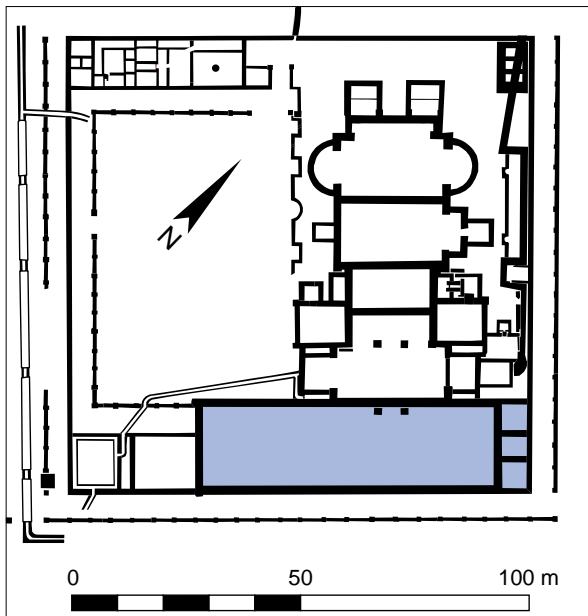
Xanten, Colonia Ulpia Traiana. Grundriss der Großen Thermen mit der Thermenhalle im Osten.
